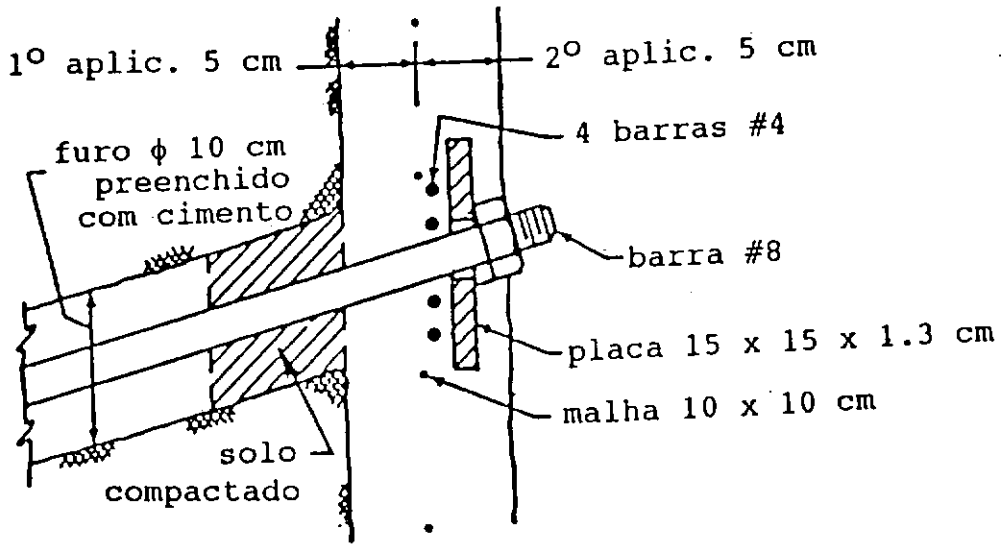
Detalhe Estrutural da Parede (Shen et al., 1978)
